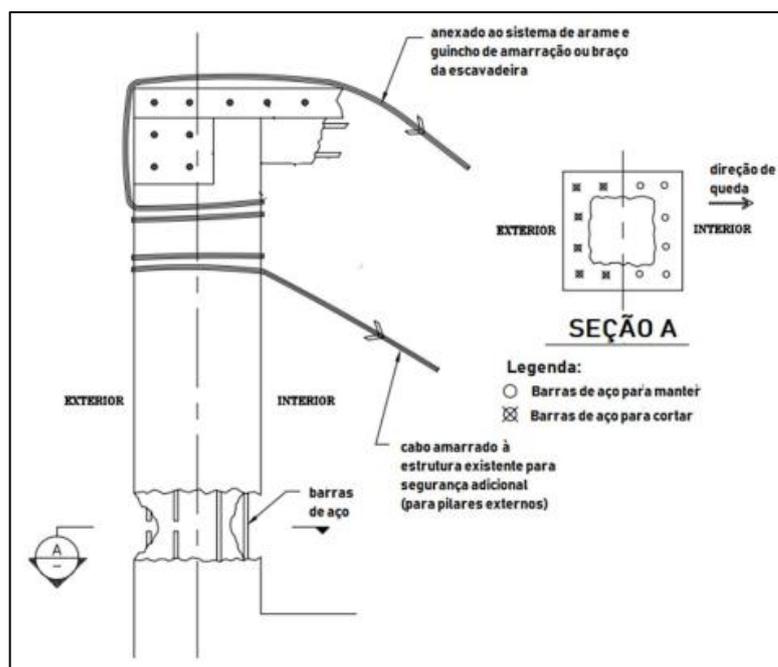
Detalhes da demolição de pilares. (fonte: BUILDINGS DEPARTMENT, 2004 (adaptado))
